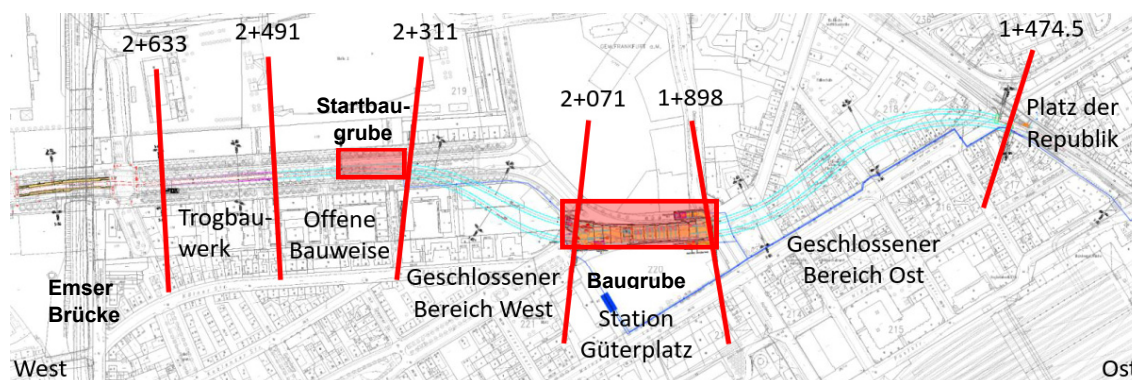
Lageplan Startbaugrube und Baugrube Station Güterplatz
